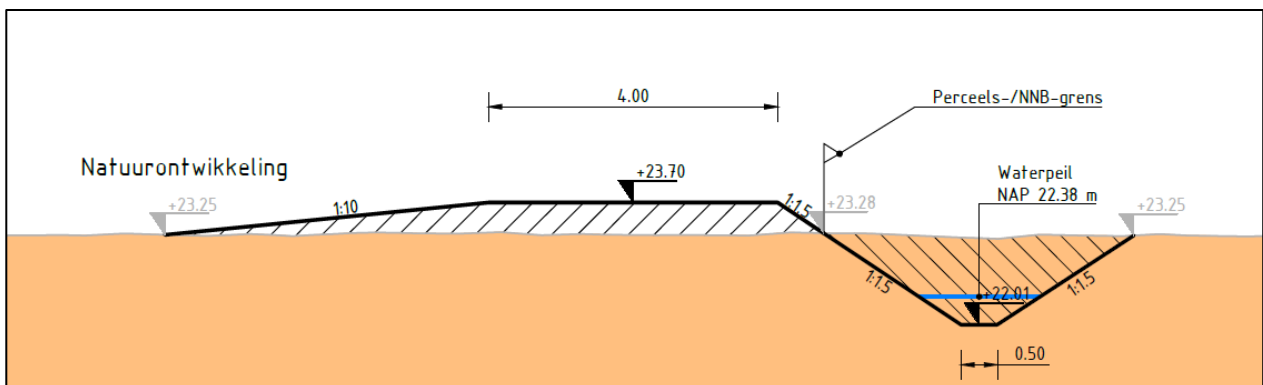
Overzicht kade en aan te brengen watergang
